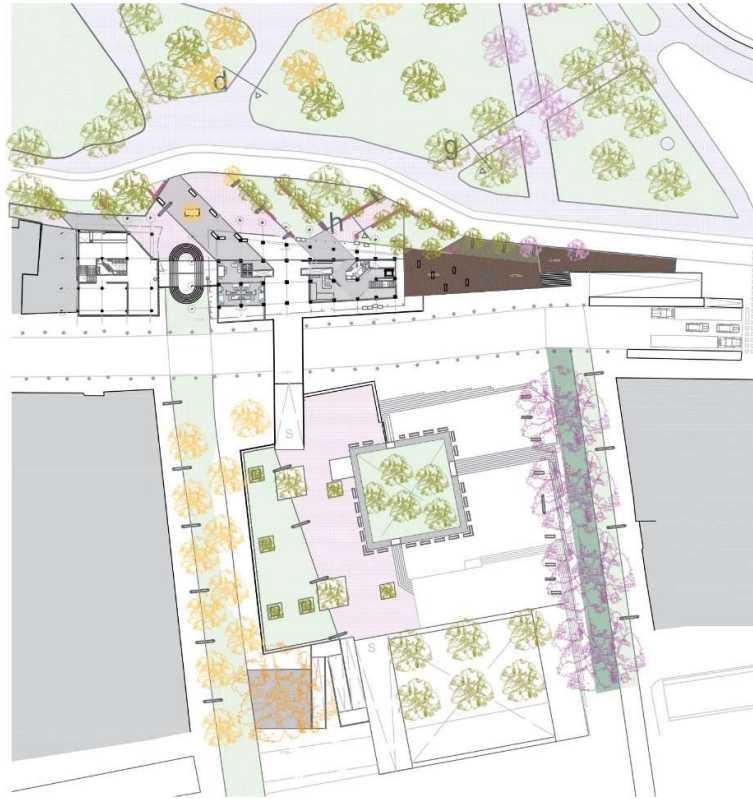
Planta Baja Alameda, 2020 (Elaborado por Loján)
